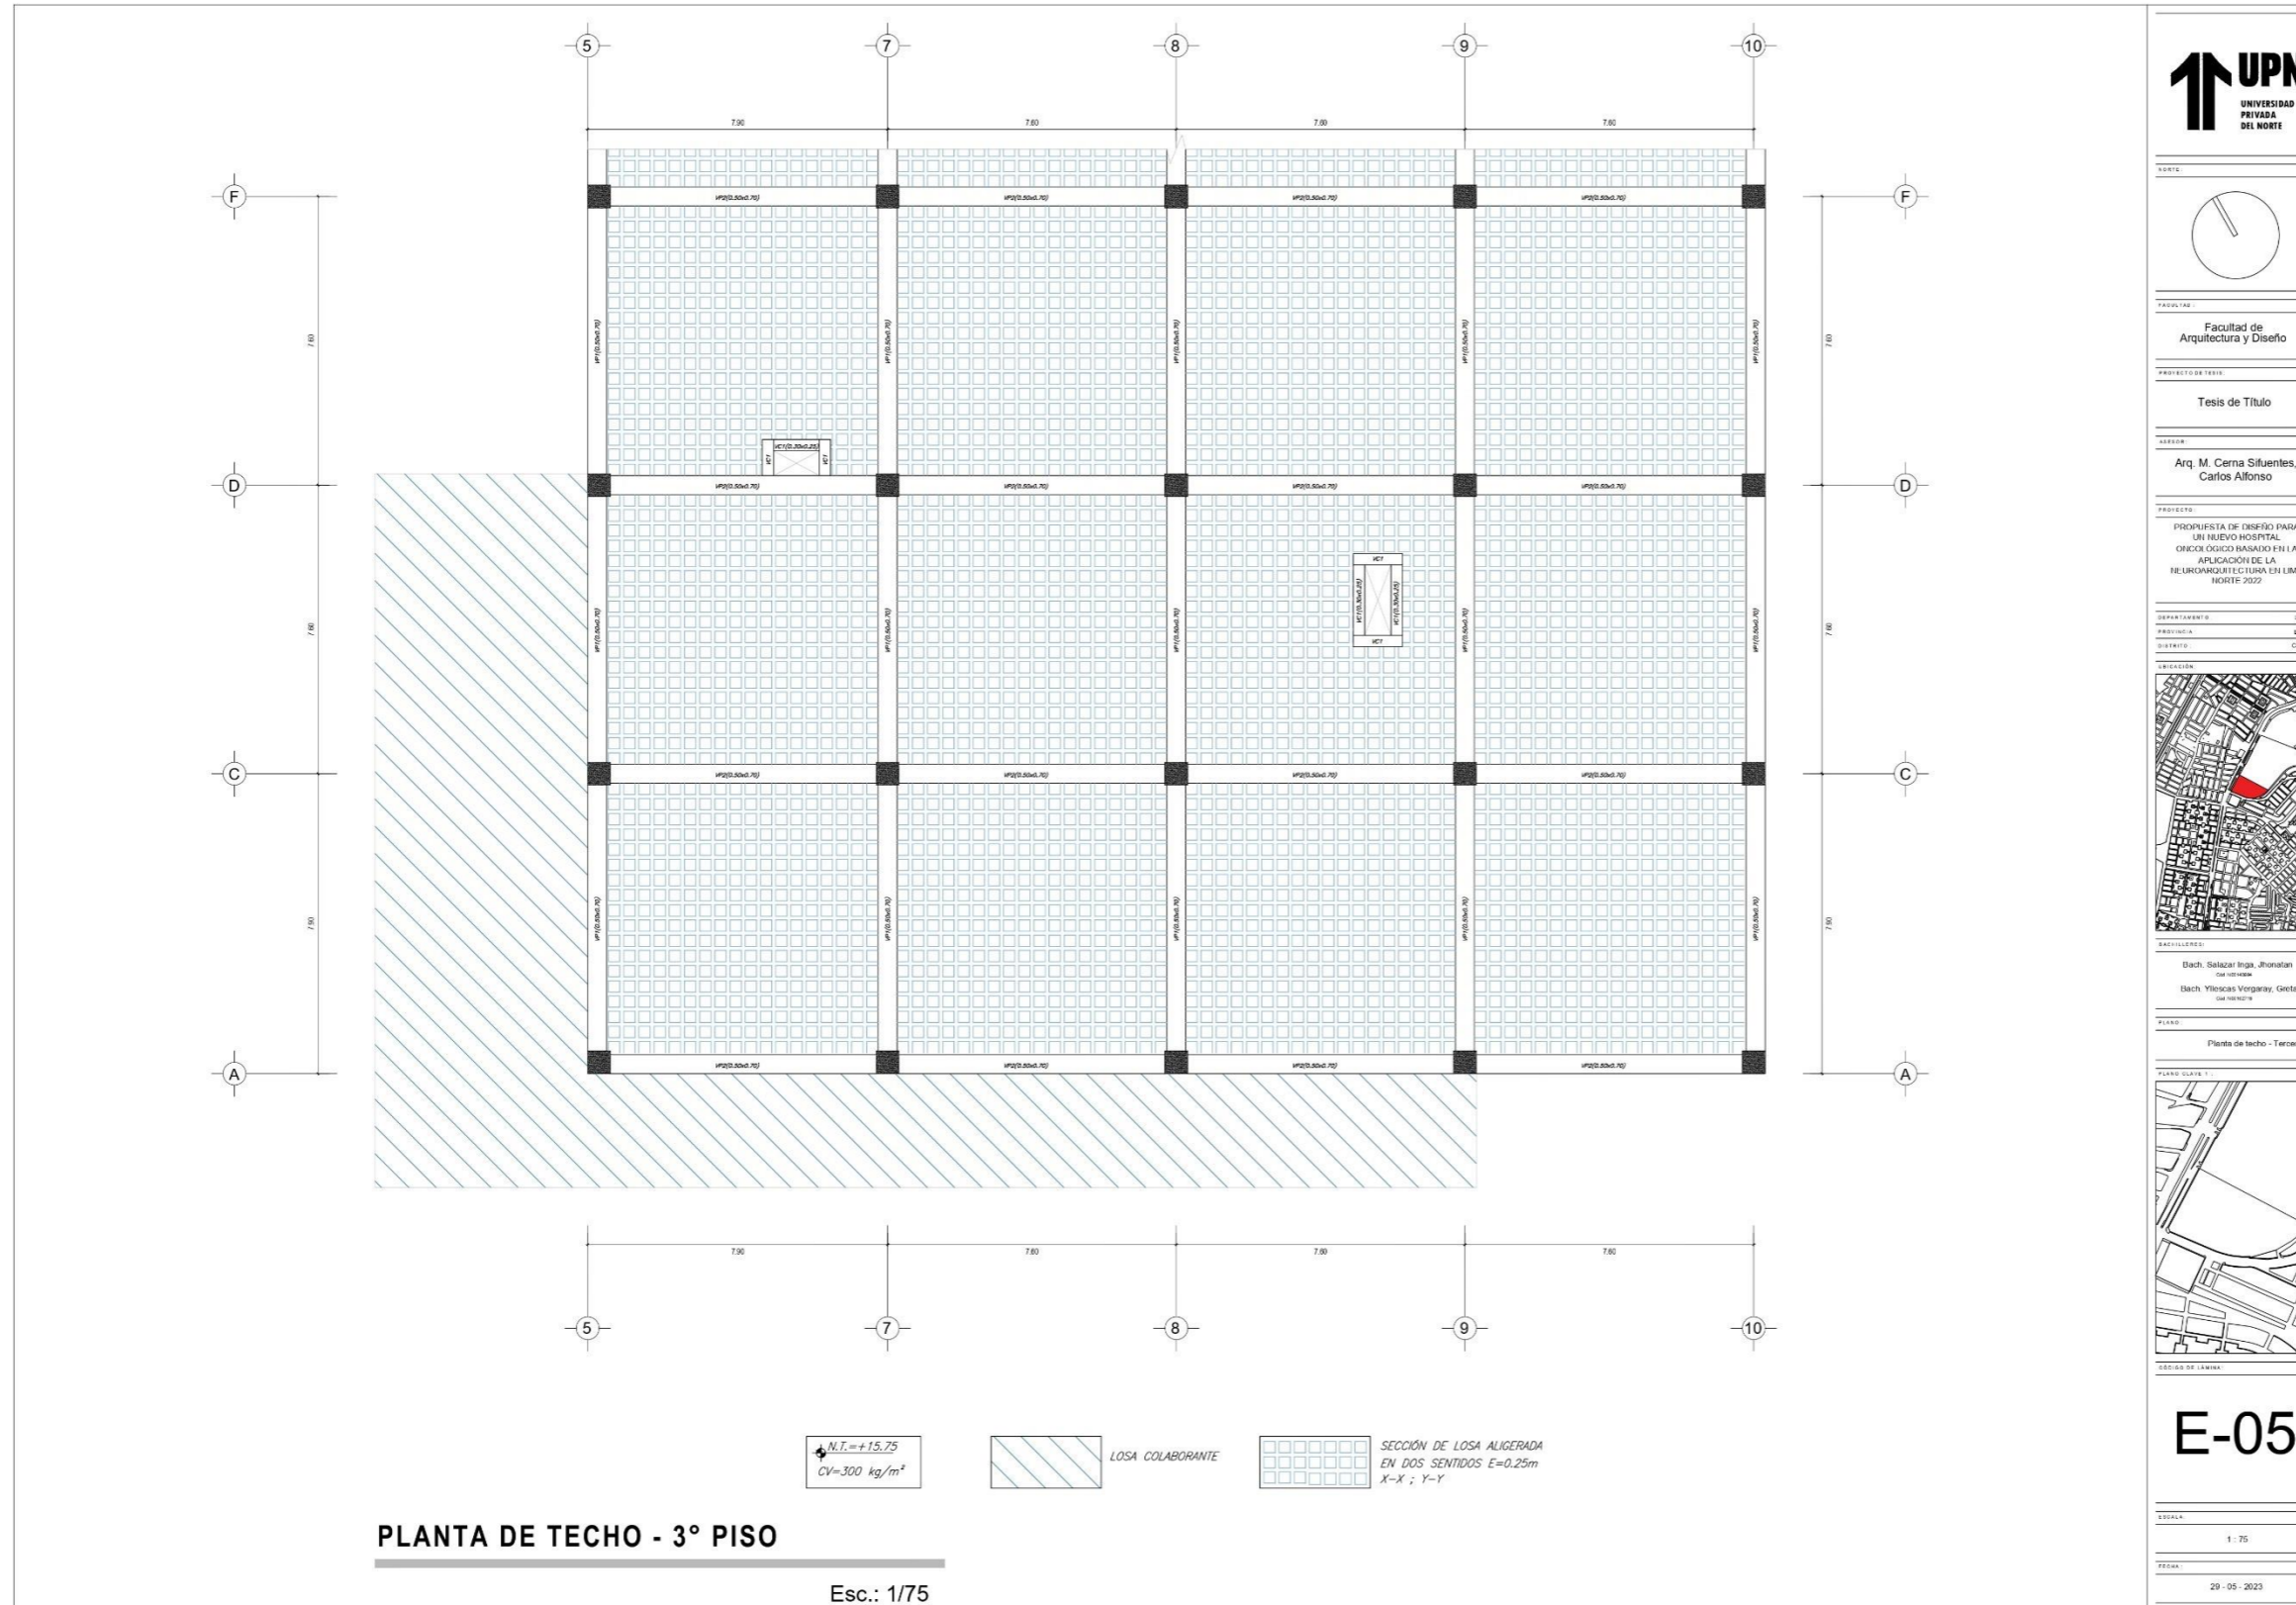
Estructuras – Aligerado planta de techo N°3 piso del sector cuadrante Esc: 1/75 (Fuente: Elaboración propia de los coautores)
